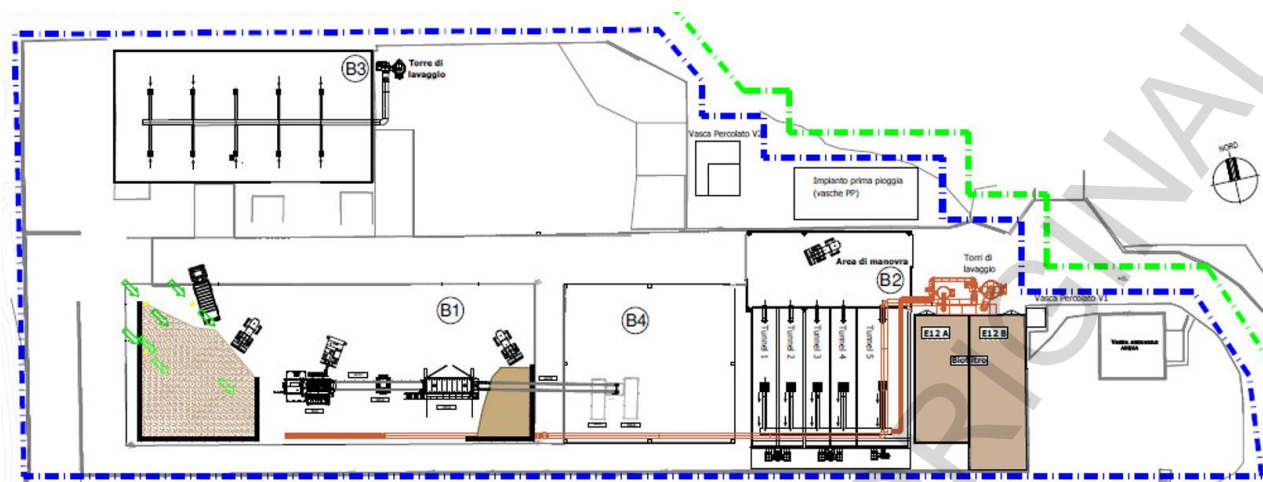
Planimetria indicante le aree di lavorazione e il biofiltro – individuate nella fase di modifica non sostanziale AIA prevista nel PAUR N.281 (Reg. Gen.) del 12/03/2024
